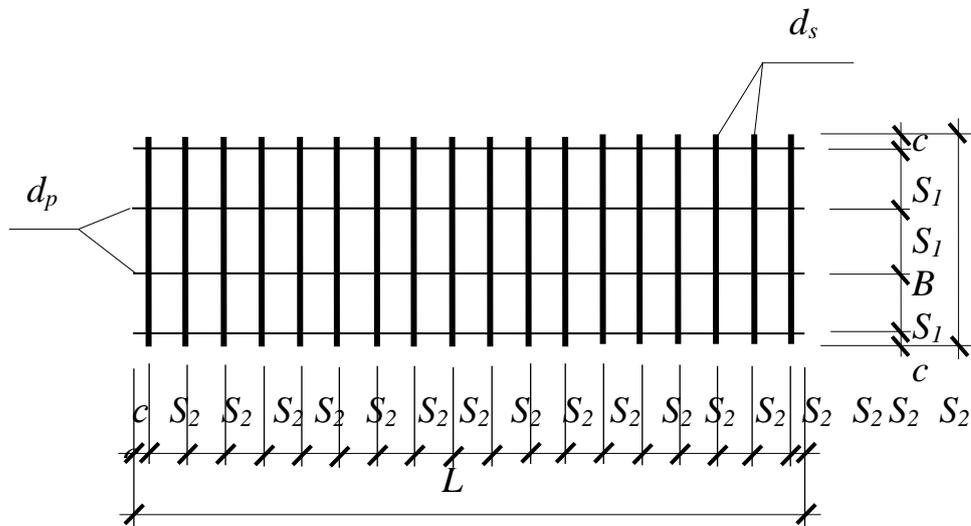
Сітка з поперечною робочою арматурою
